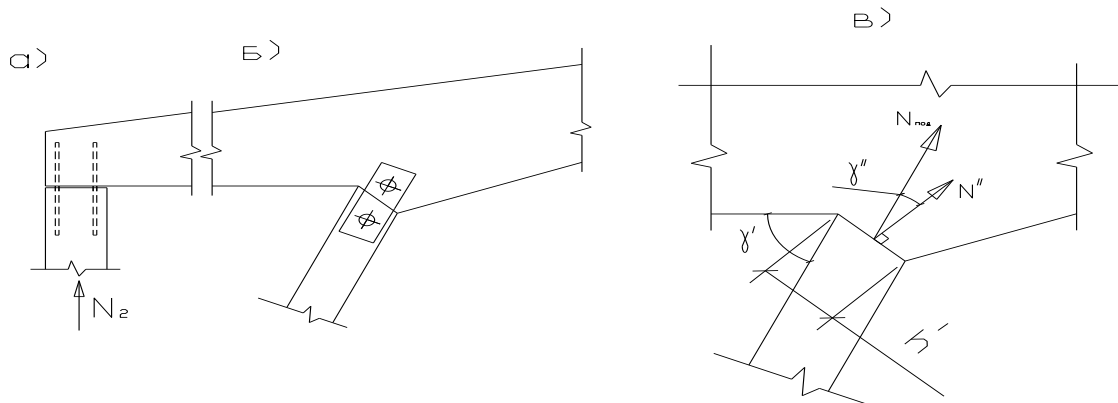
Схема крепления карнизного узла: а) крепления стойки с ригелем, б) крепление подкоса с ригелем, в) схема крепления подкоса
